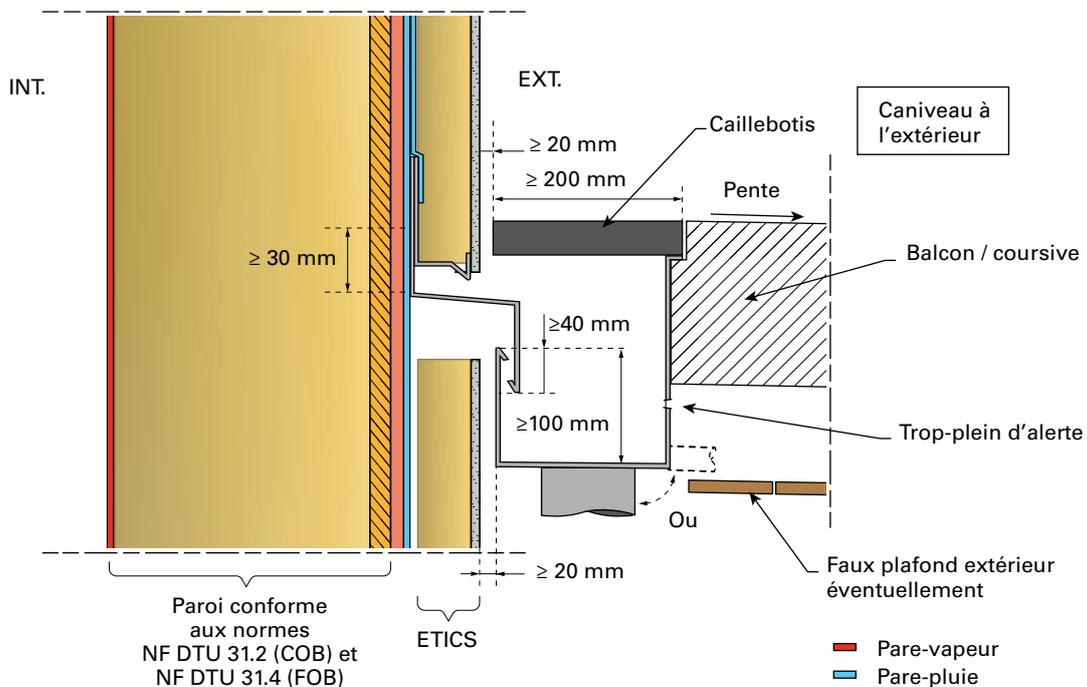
Exemple de traitement d'un balcon désolidarisé directement circulaire (au niveau d'un seuil de porte et d'une paroi opaque)
